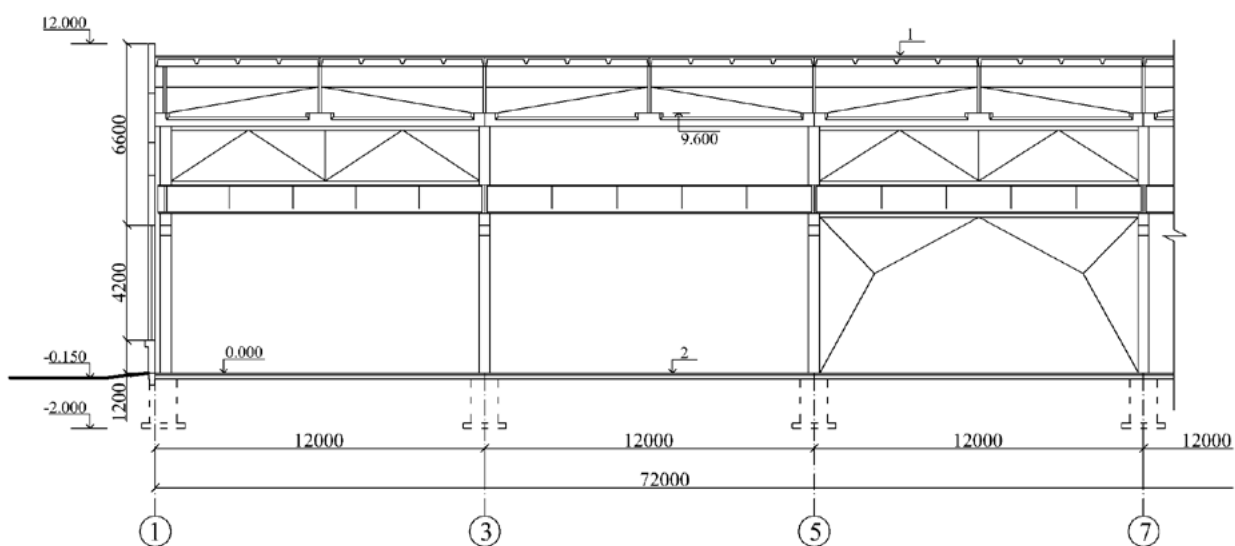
Пример фрагмента продольного разреза производственного здания с железобетонным каркасом:
